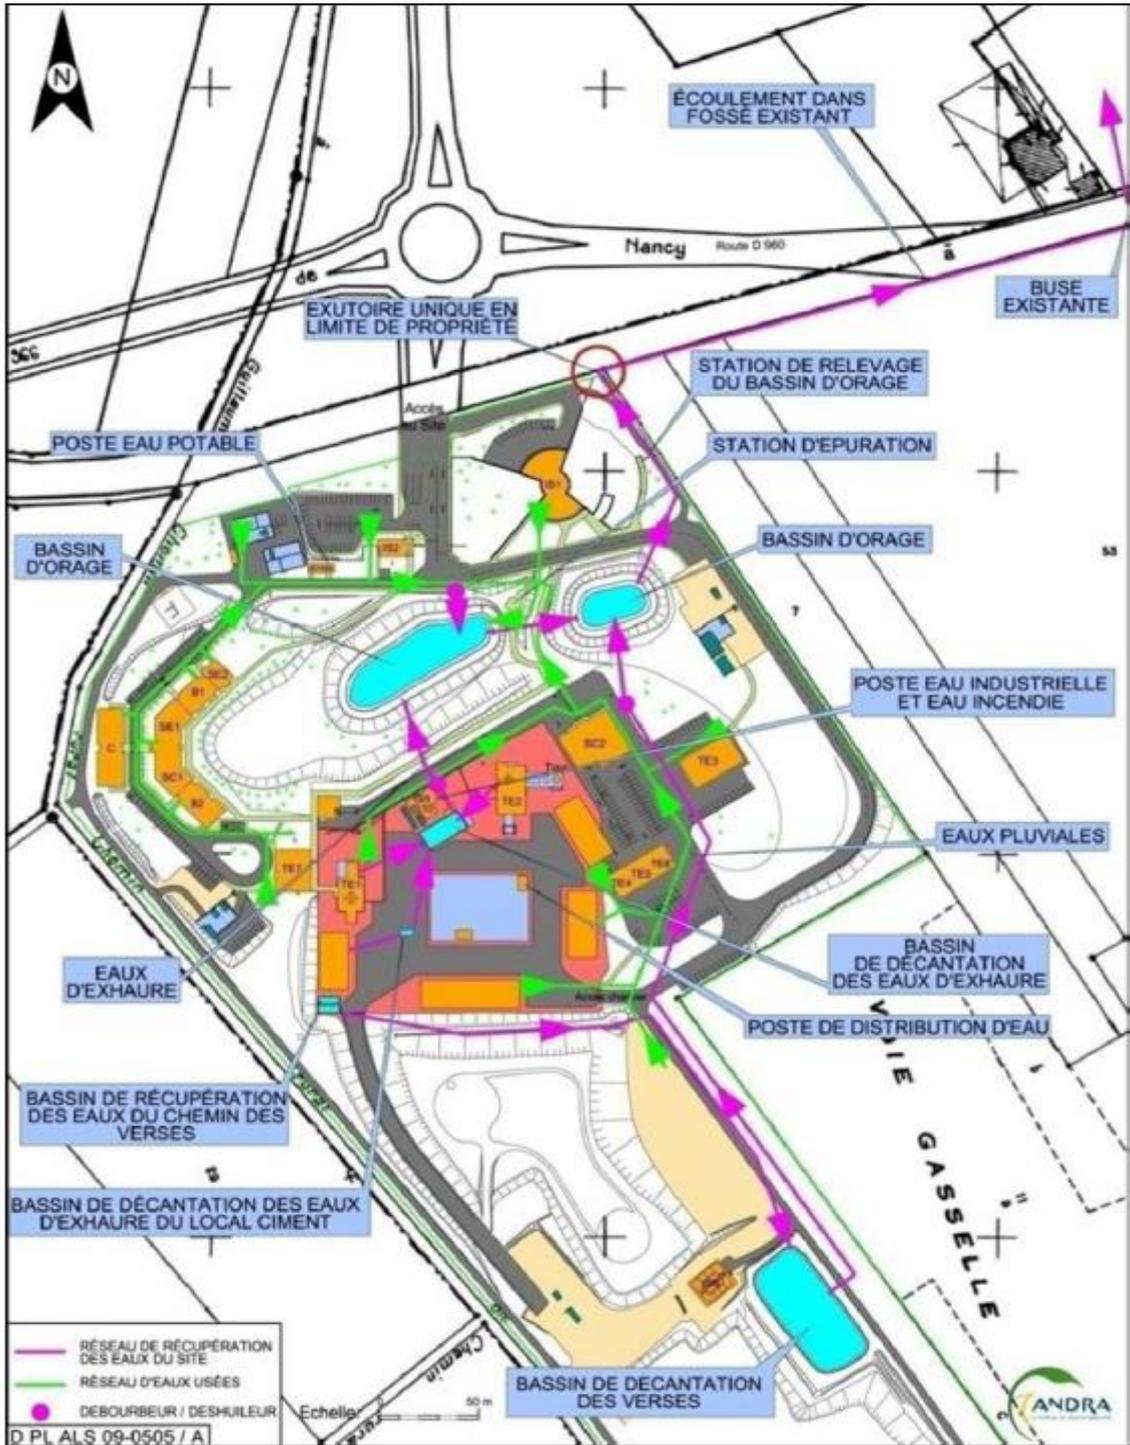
Extrait du plan des réseaux d'assainissement du Laboratoire souterrain
